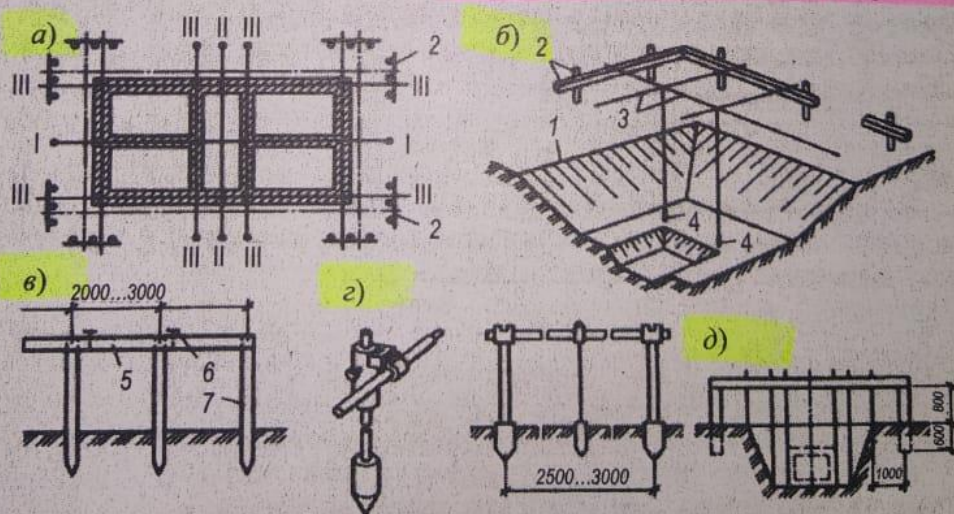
Схема разбивки котлованов и траншей: а — схема разбивки котлована; б — схема обноски; в — элементы обноски; г — инвентарная металлическая обноска; д — схема разбивки траншеи; I-I, II-II — главные оси здания; III-III — оси стен здания. 1 — границы котлована; 2 — обноска; 3 — проволока-причалка; 4 — отвесы; 5 — доска; 6 — гвоздь; 7 — стойка
